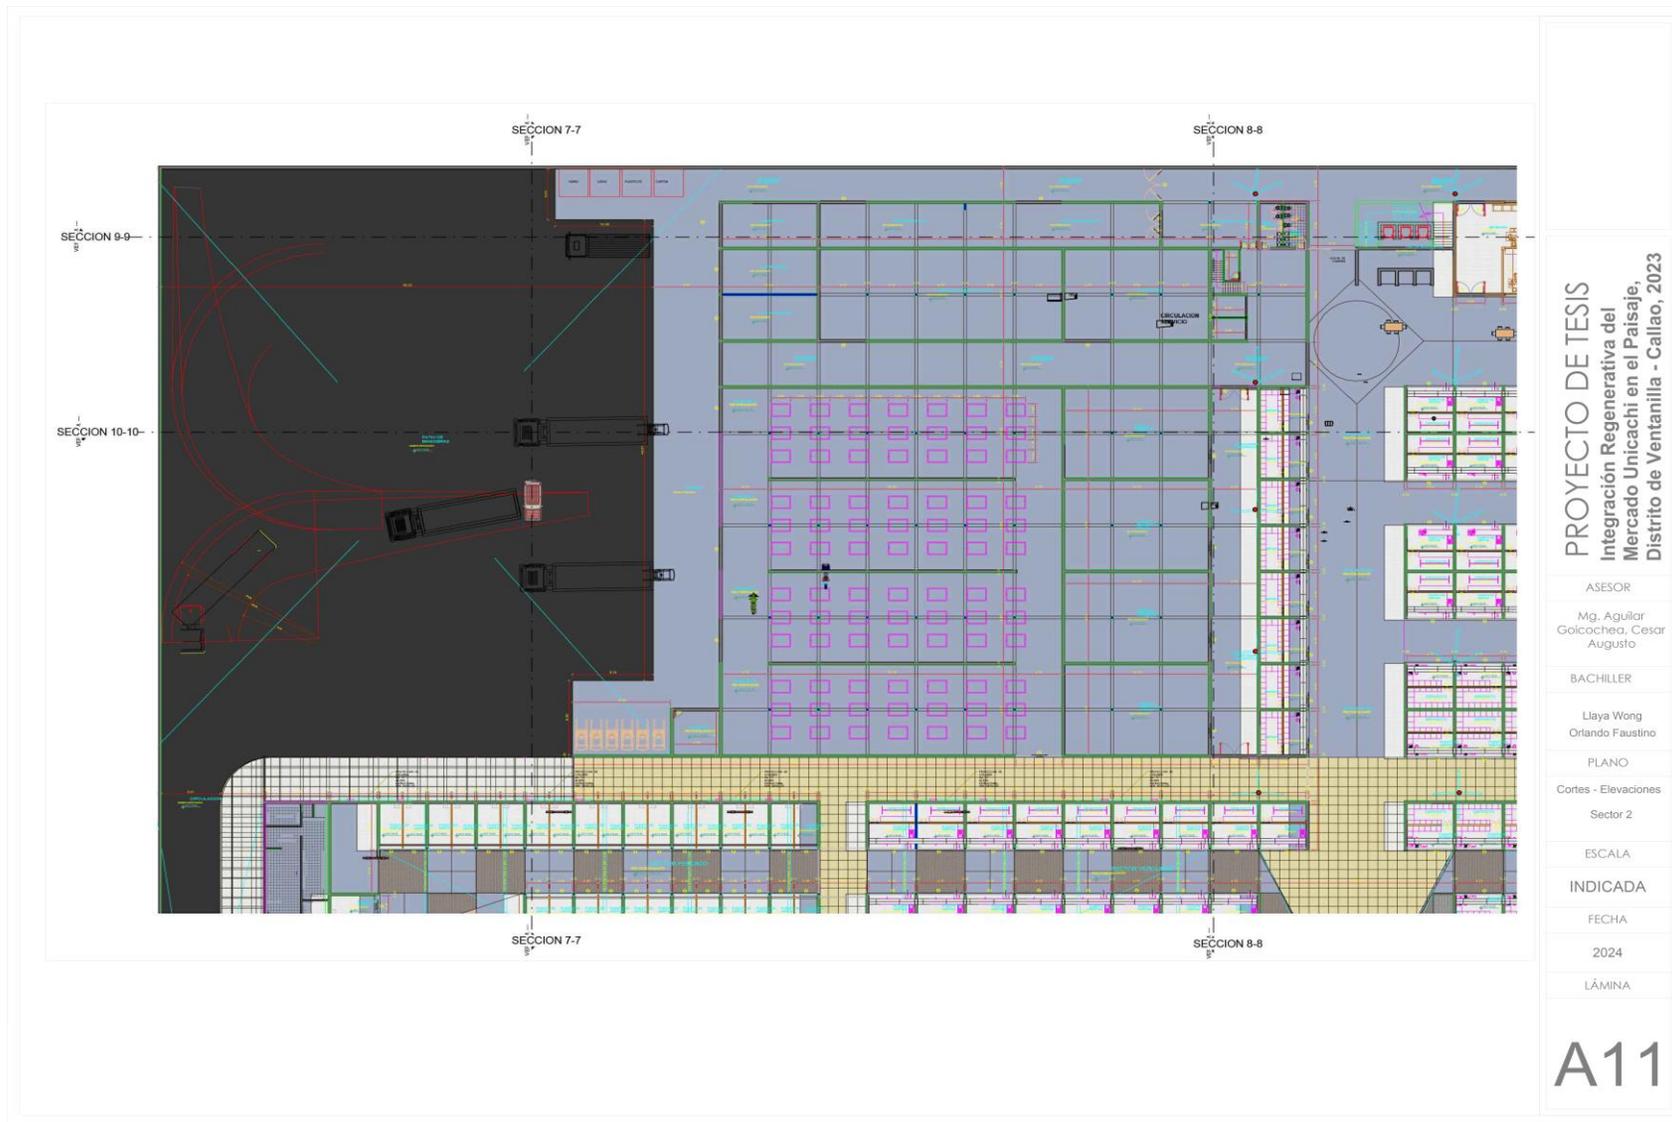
Plano de distribución por sector 2- cortes elevaciones, elaboración propia.
